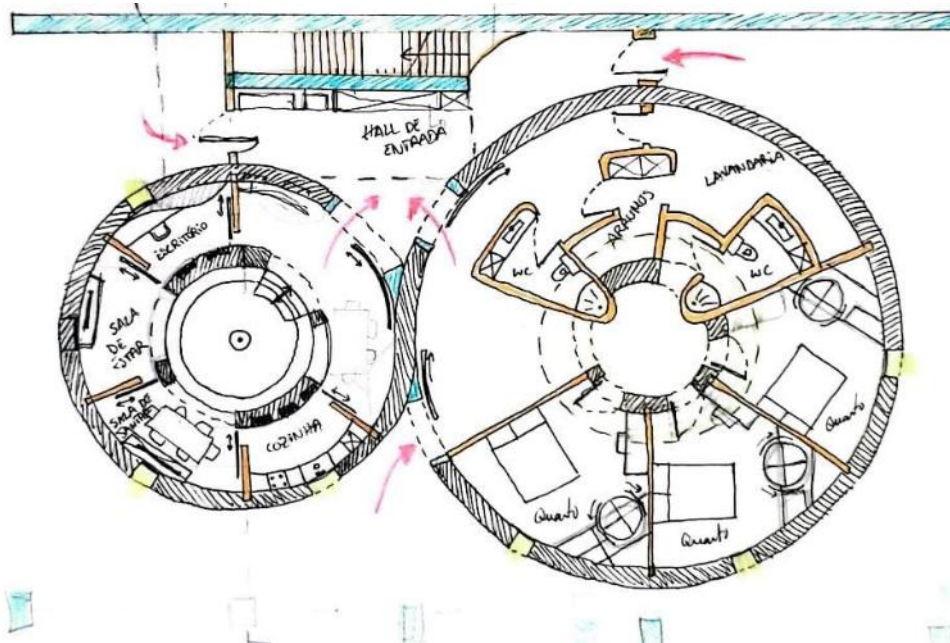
Estudo da planta de piso térreo. (Autora, 2025)
